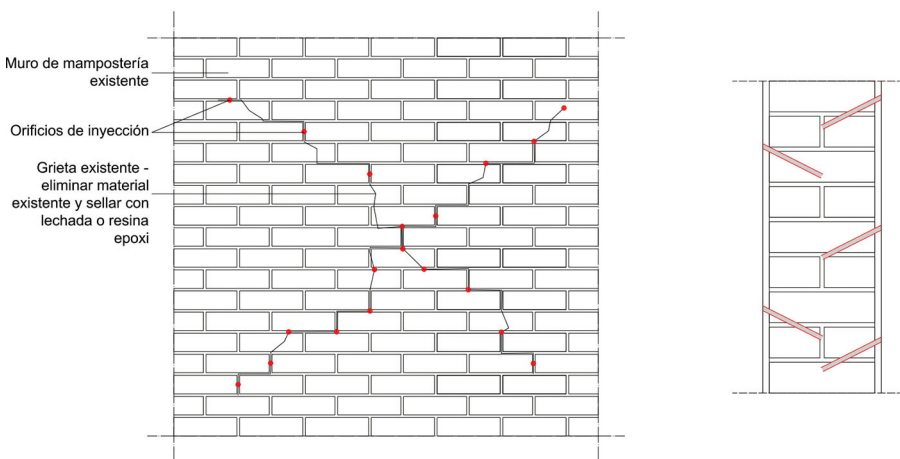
Inyección de lechada o resina epoxi en grietas. Esquema y detalle constructivo.
